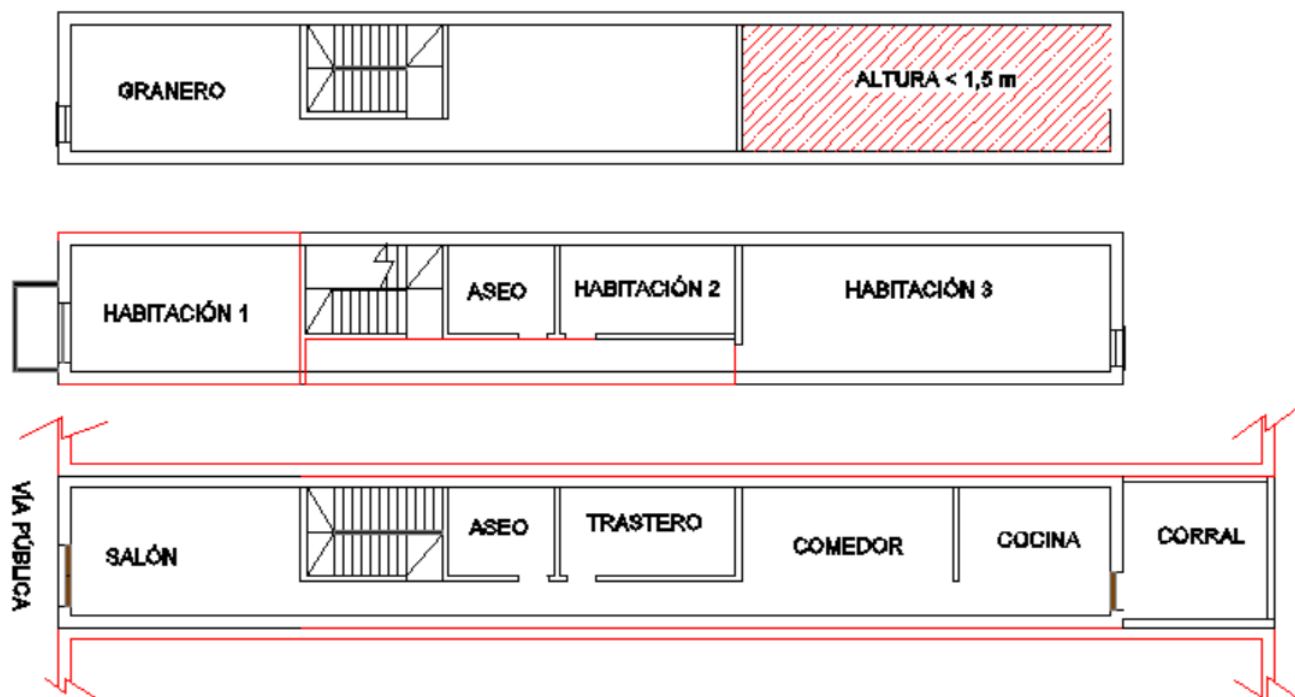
Plano de plantas de la vivienda modelo. Elaboración propia.
